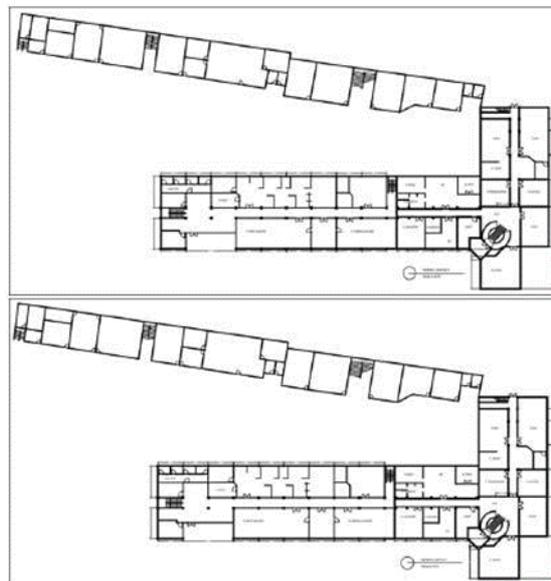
Denah Lantai 1 dan 2 Pertamina 1920
